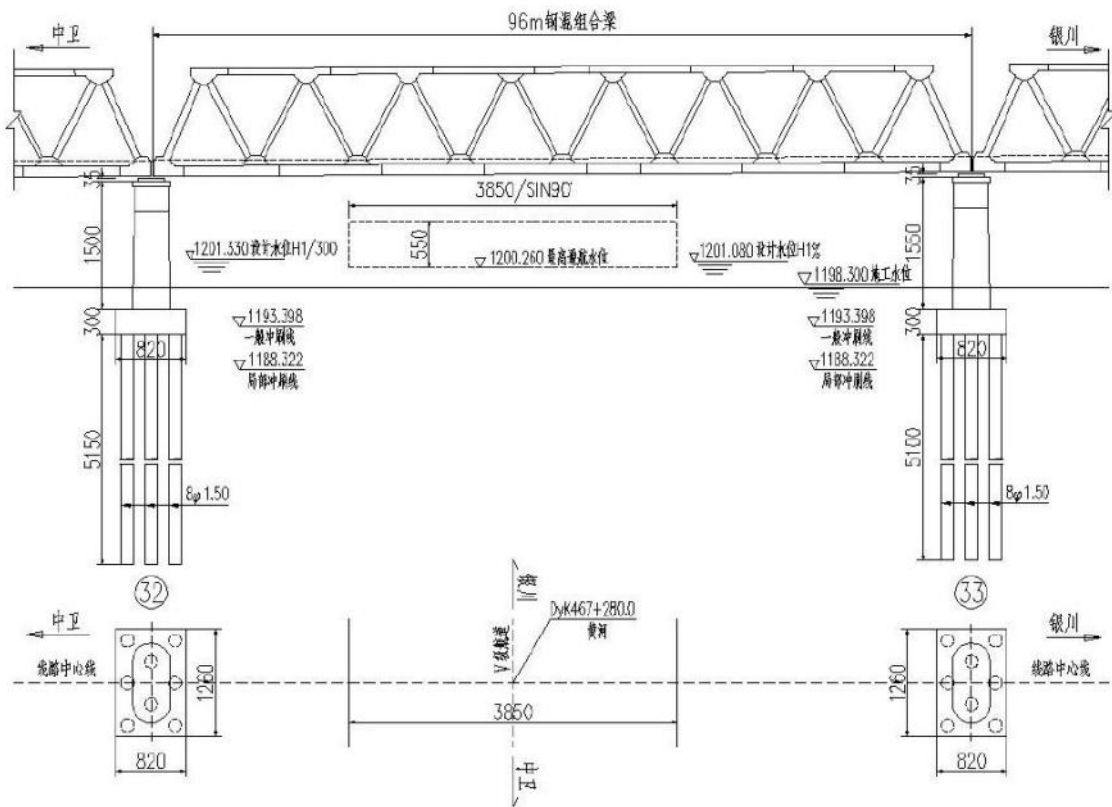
宝中铁路二线黄河特大桥(跨越黄河处)立面图
